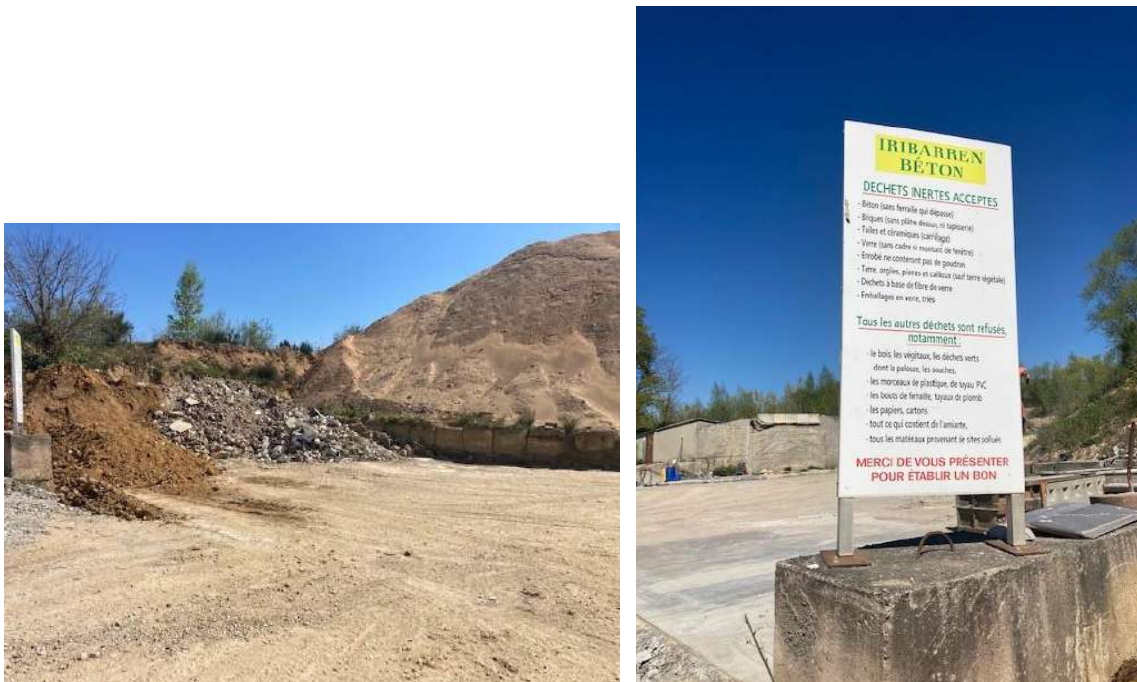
Zone de réception des matériaux extérieurs sur le site des Hauts-Fourneaux (IRIBARREN, avril 2023)
